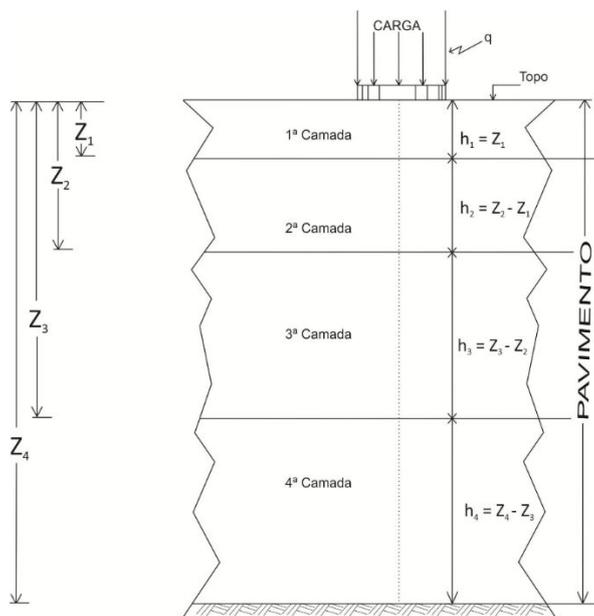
Seção transversal típica de um pavimento. Fonte: Senço, 2007 (adaptado).
